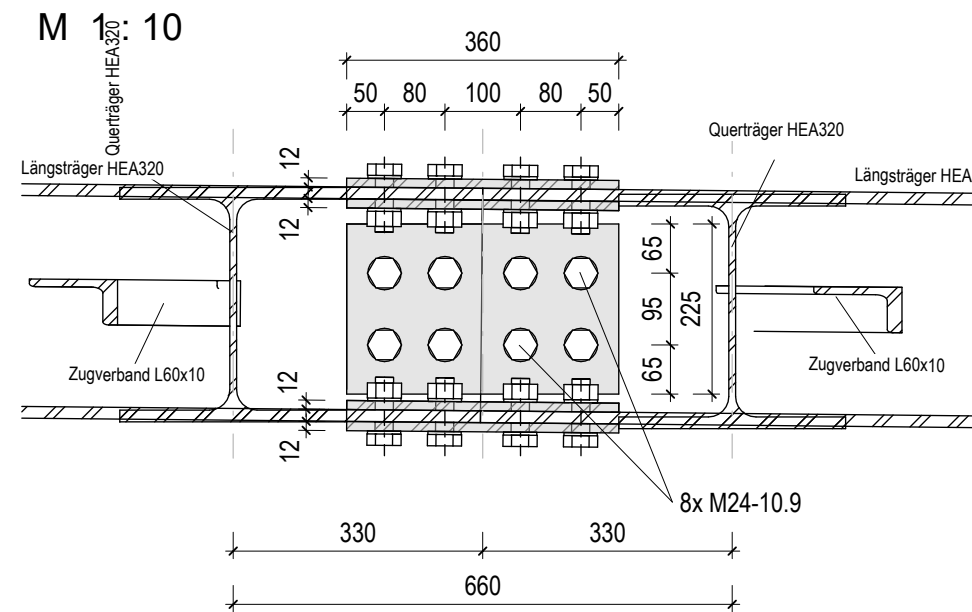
Laschenstoß Untergurt- Längsträger HEA320
